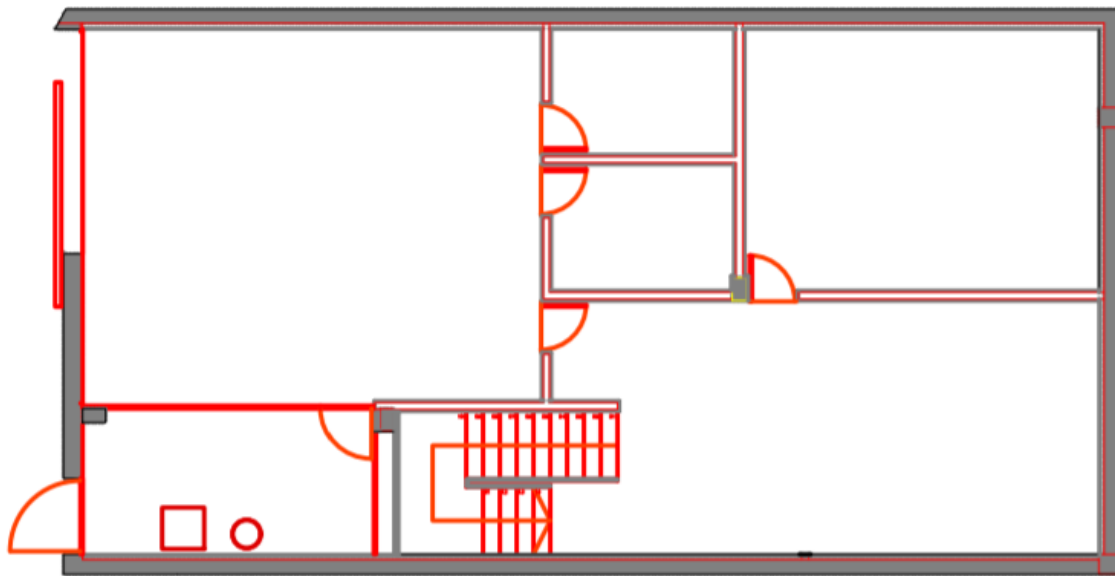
Elaboración propia. Plano de distribución del sótano de la vivienda.
